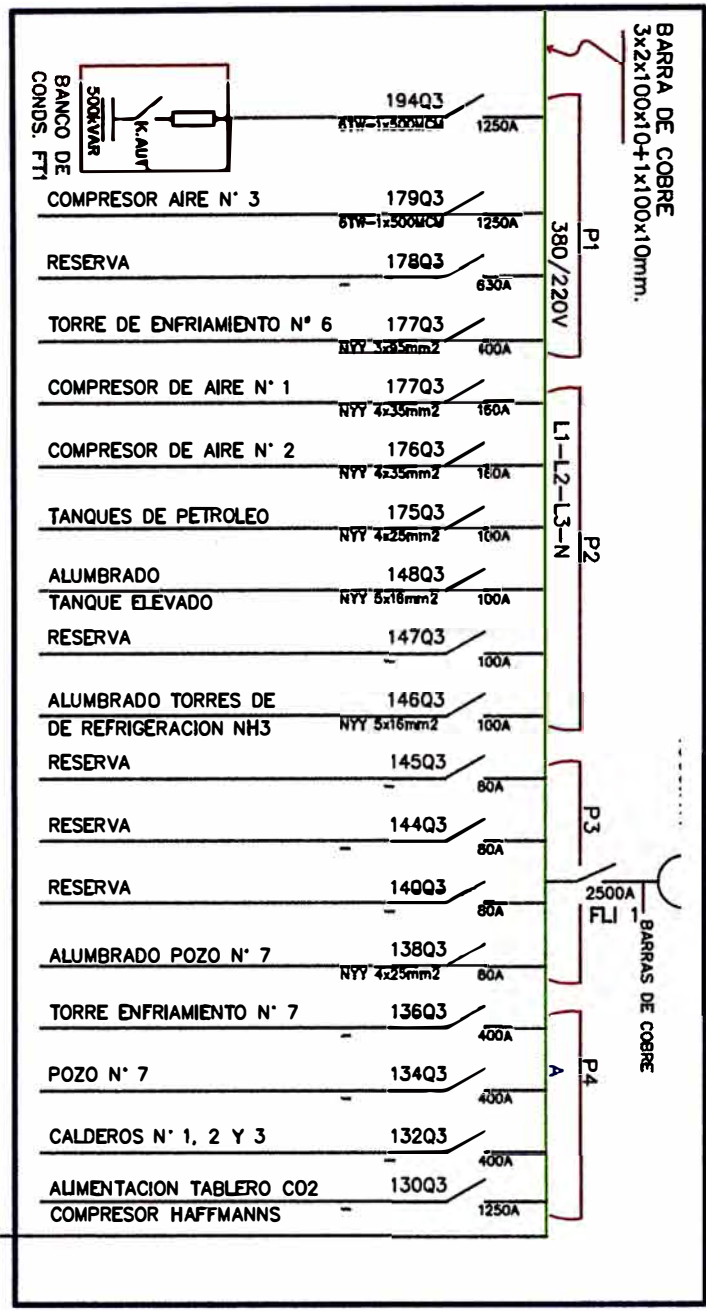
Subestación eléctrica F2 (Planta de Fuerza2) – Tablero 1
